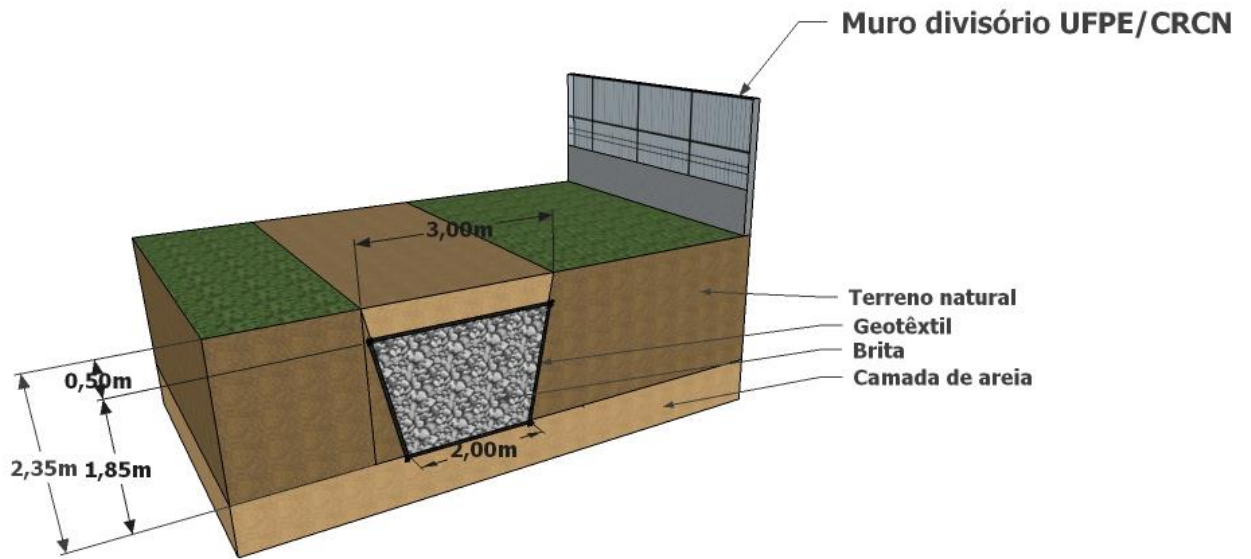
Seção transversal com vista isométrica da trincheira de infiltração
